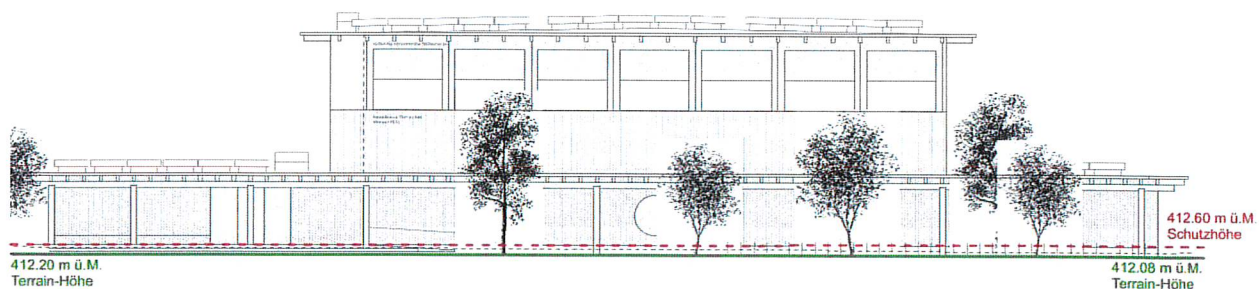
Fassadenansicht Südost-Nordost mit eingezeichneter Schutzhöhe und Terrainhöhe. Plan aus Vorprojekt Stand 23.10.2025
